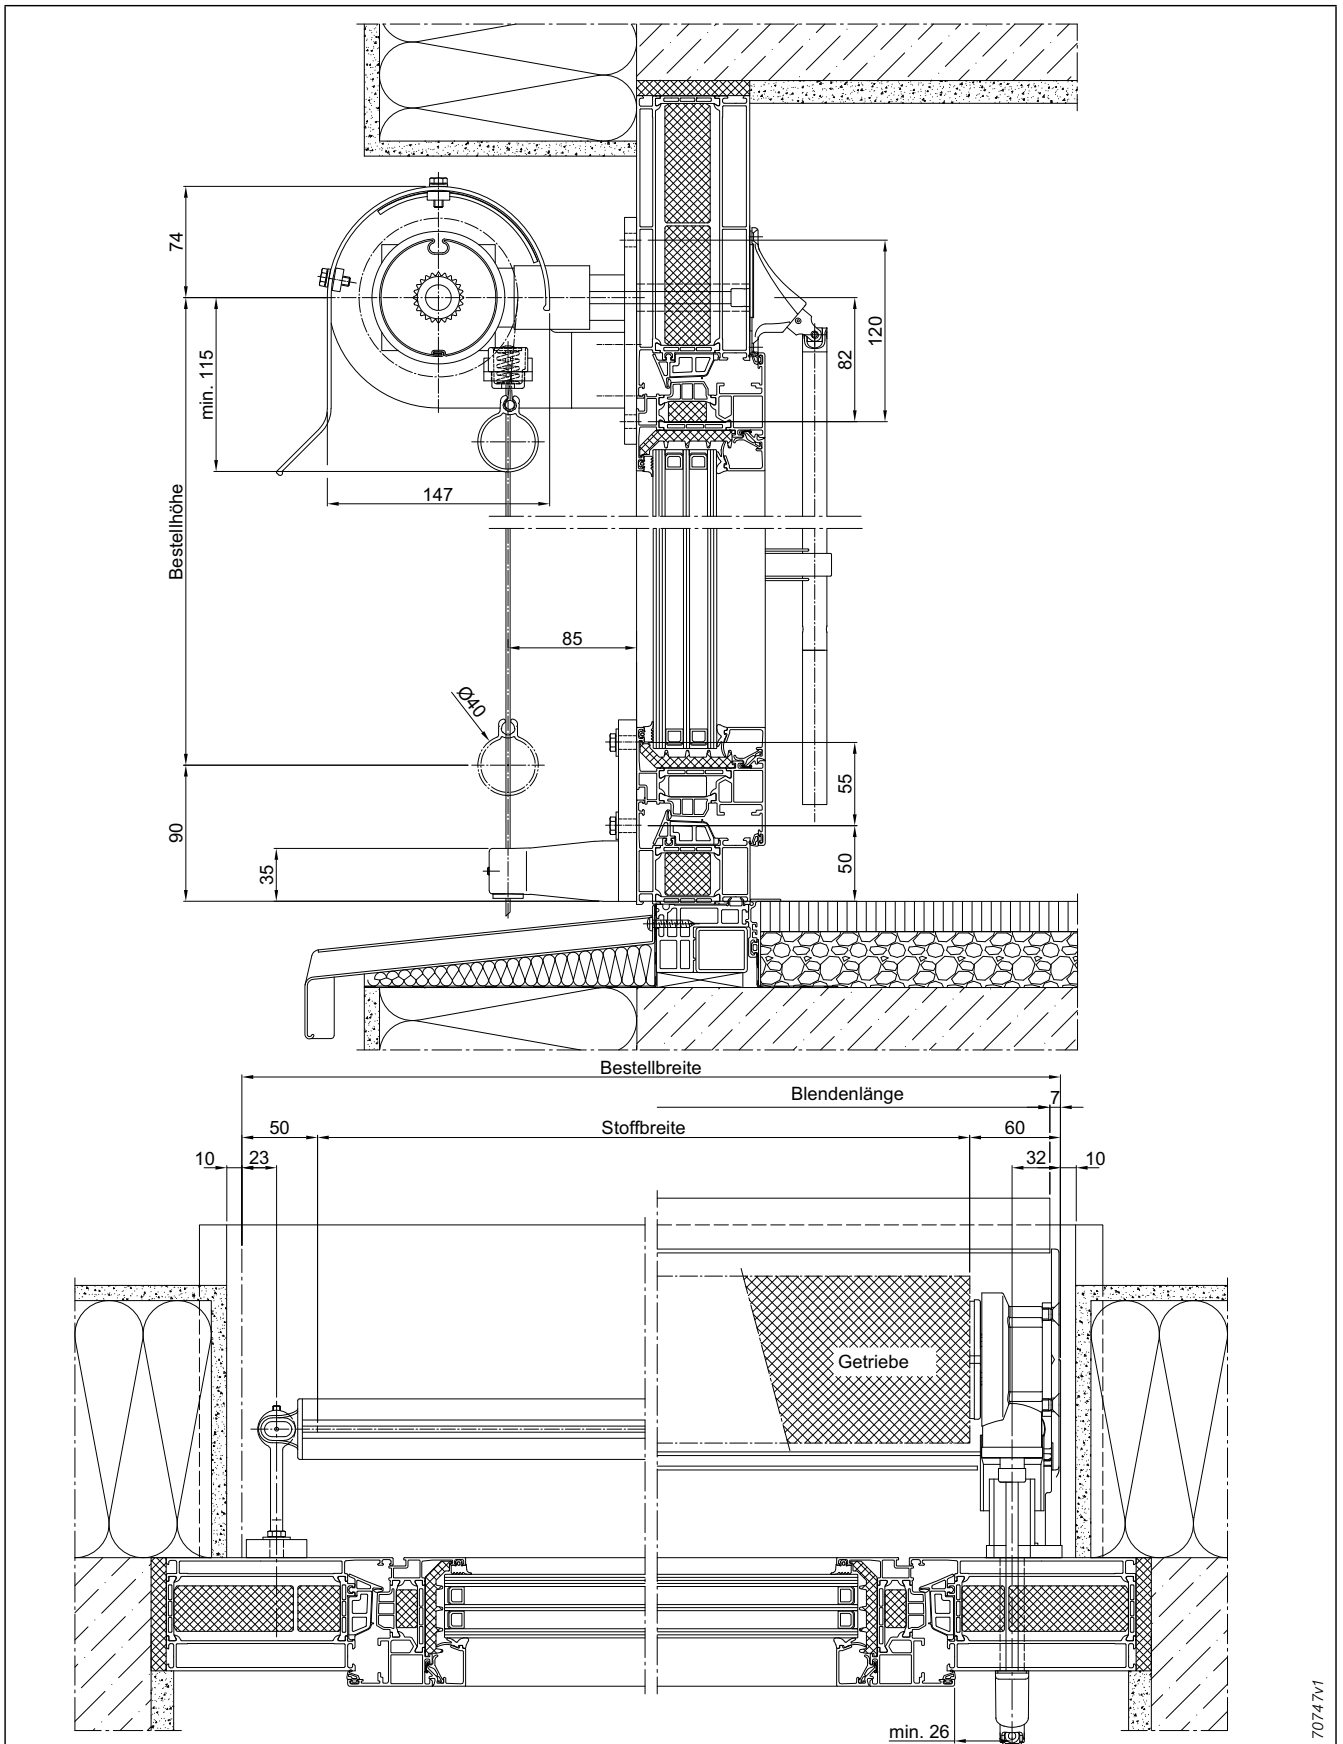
Fassaden-Markise 207 mit Halbrundblende Typ 2.3 in Laibung montiert
